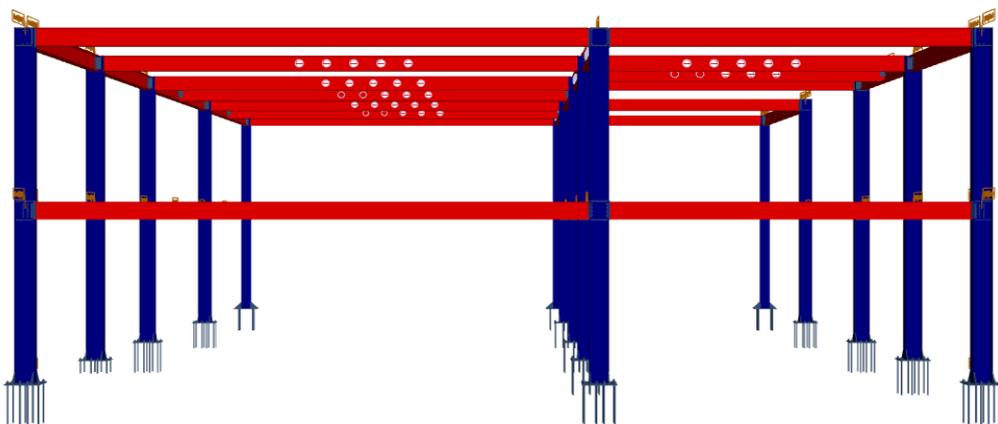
Estrutura de Aço – Estrutura Finalizada vista lateral
